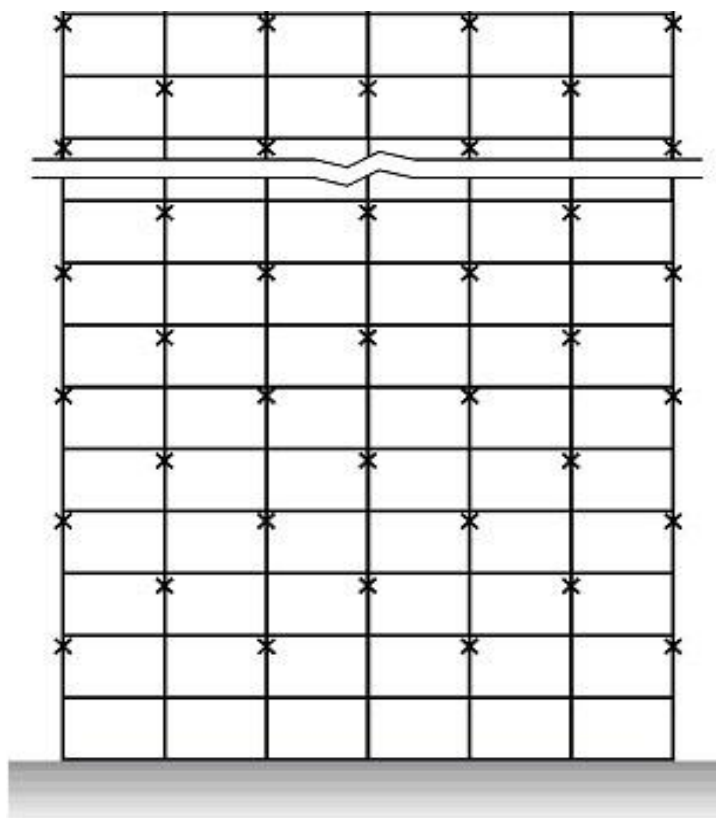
Схема крепления лесов к стене (X - место крепления)
